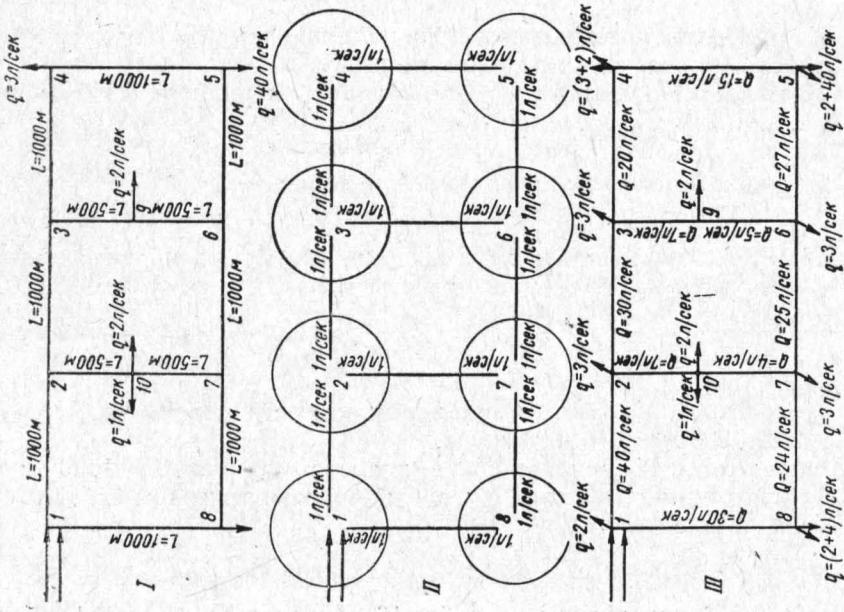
Схема для примера (расчет наружной водопроводной сети населенного пункта).
